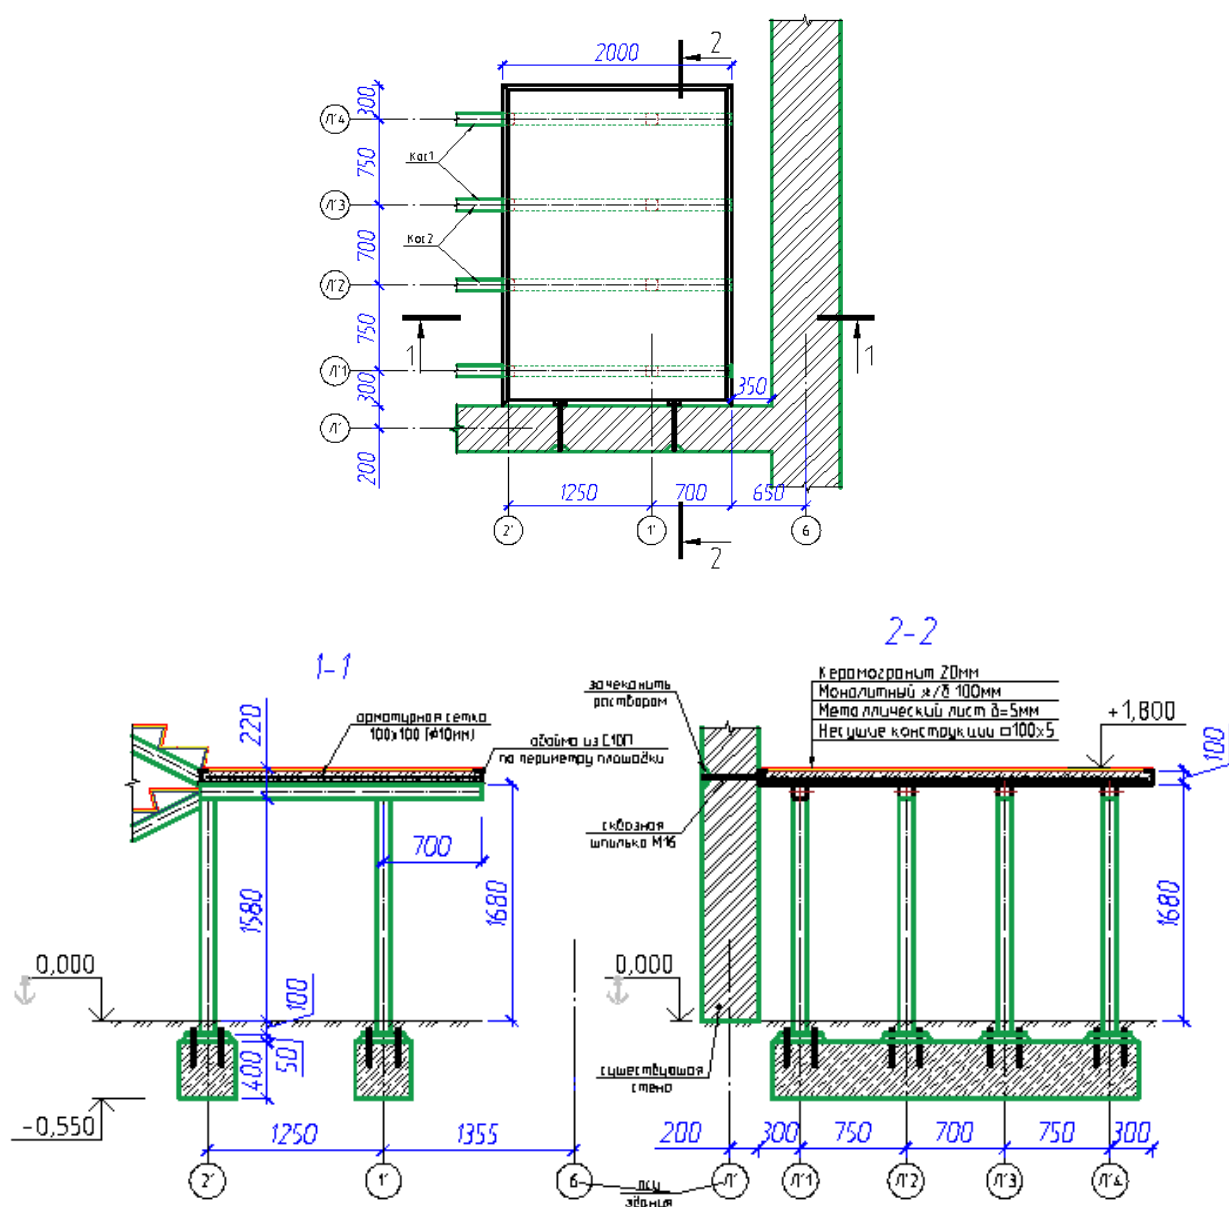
К конструированию лестничной площадки Лп1
